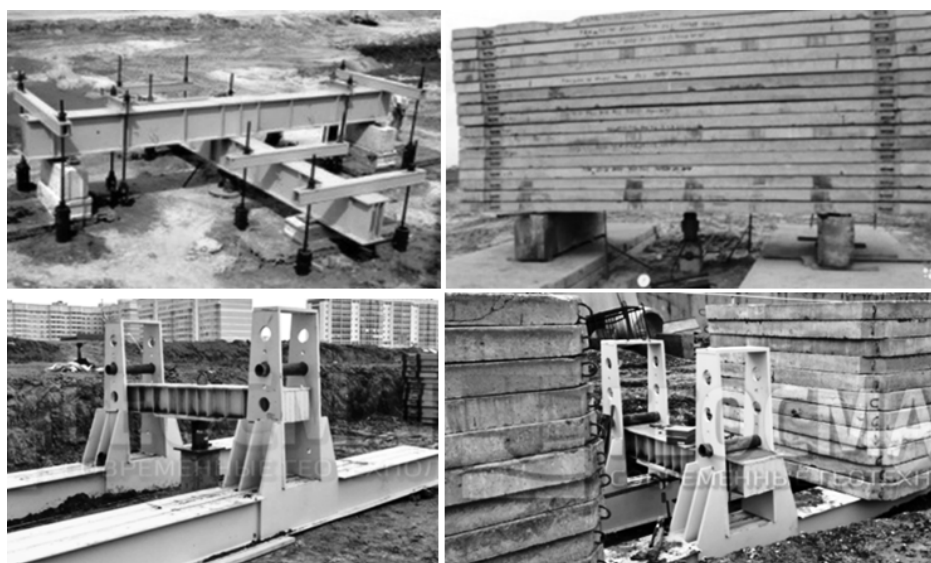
Проведение статических испытаний грунтов с использованием балок, пригруза или специальных грузовых платформ
